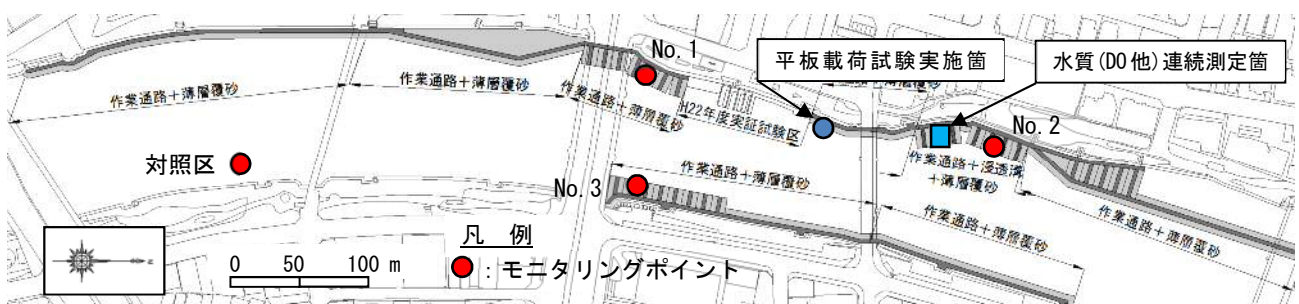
大規模実証試験施工平面図および調査箇所<sup>8)</sup>
